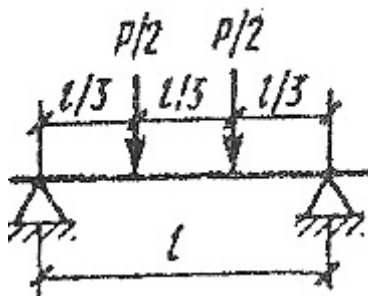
Dispositif de chargement pour l'essai de flexion [110].
